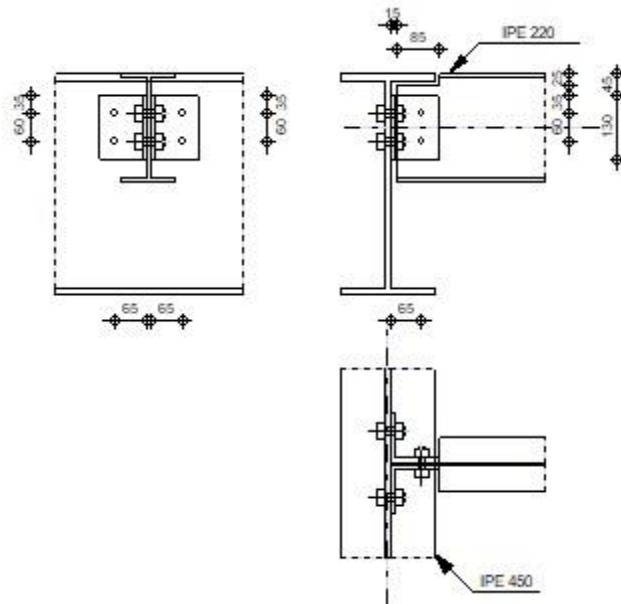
schéma assemblage -poutre principale - solive.
